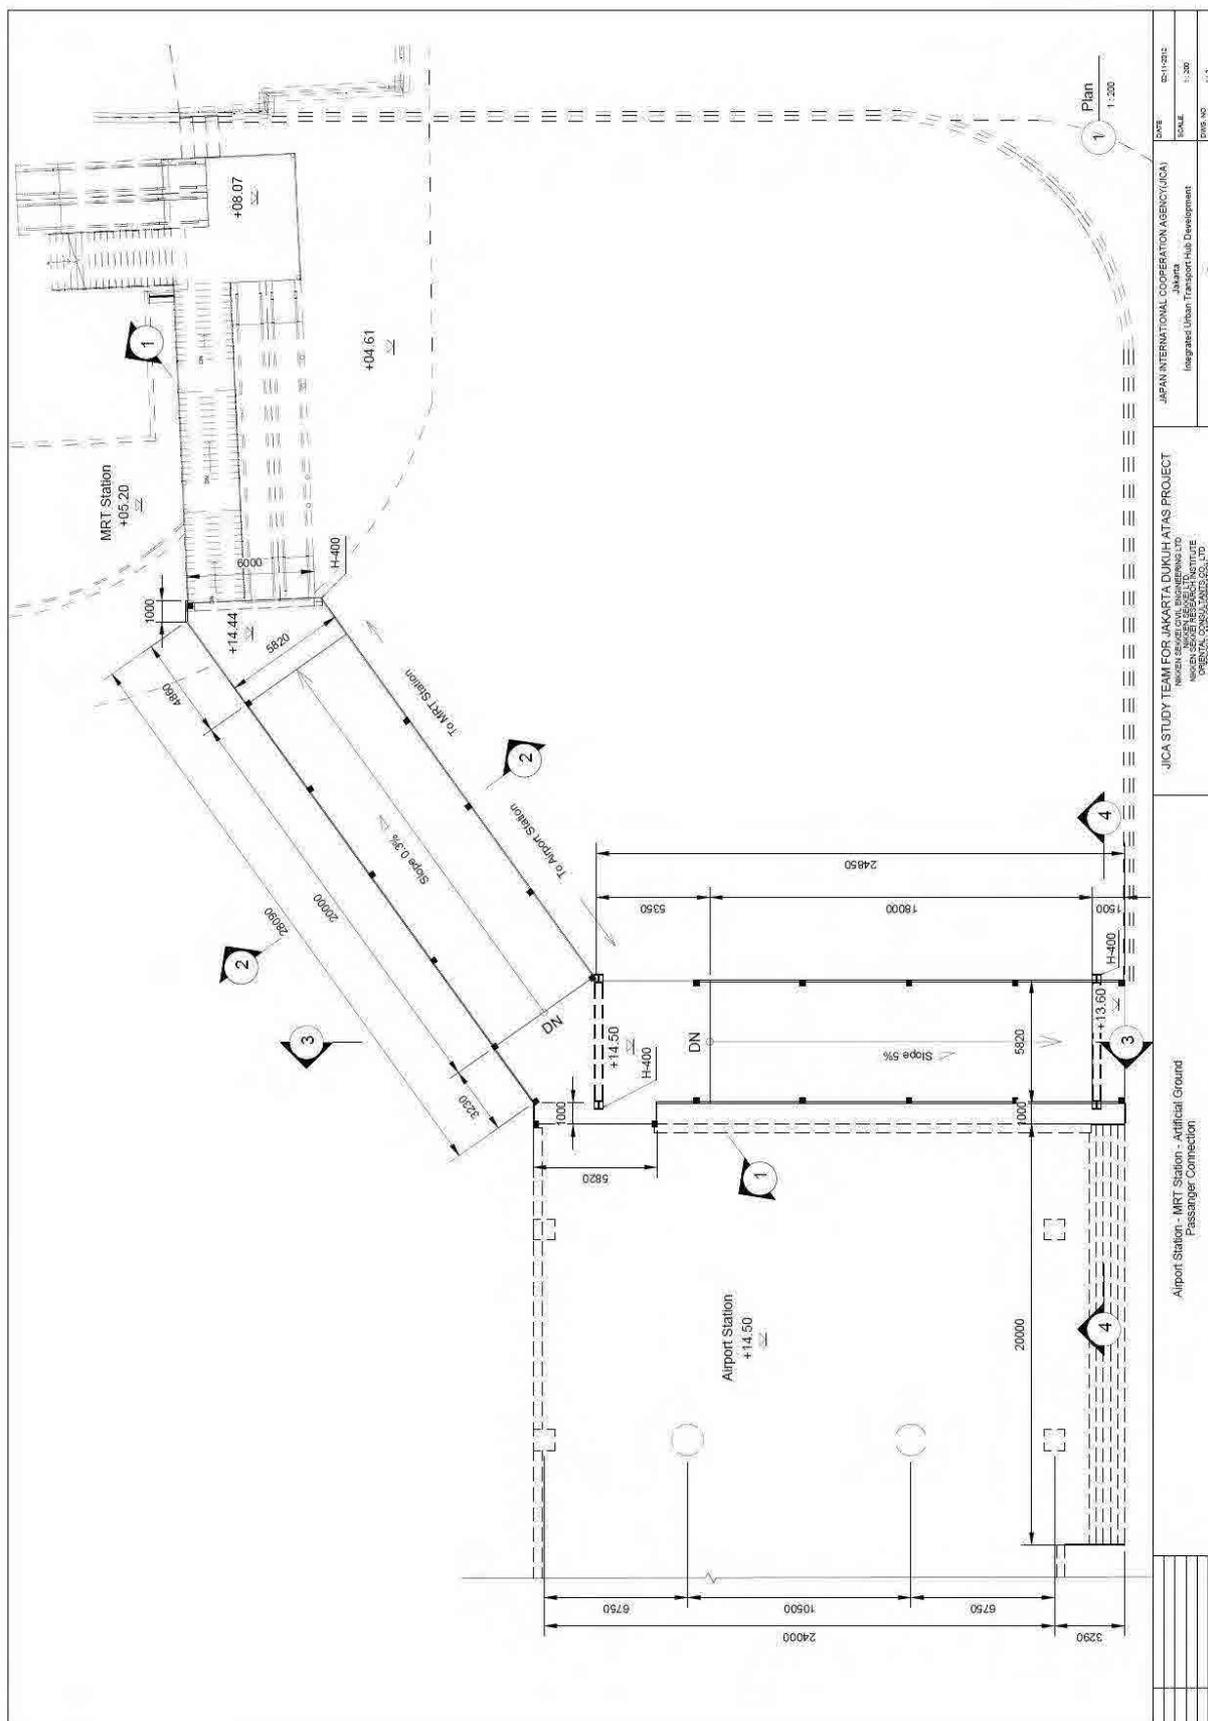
空港線-MRT 南北線連絡通路平面図 (出典：調査団)
